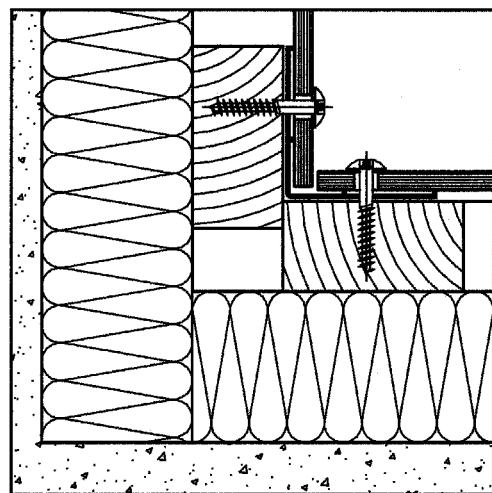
binnenhoek (horizontale doorsnede)
